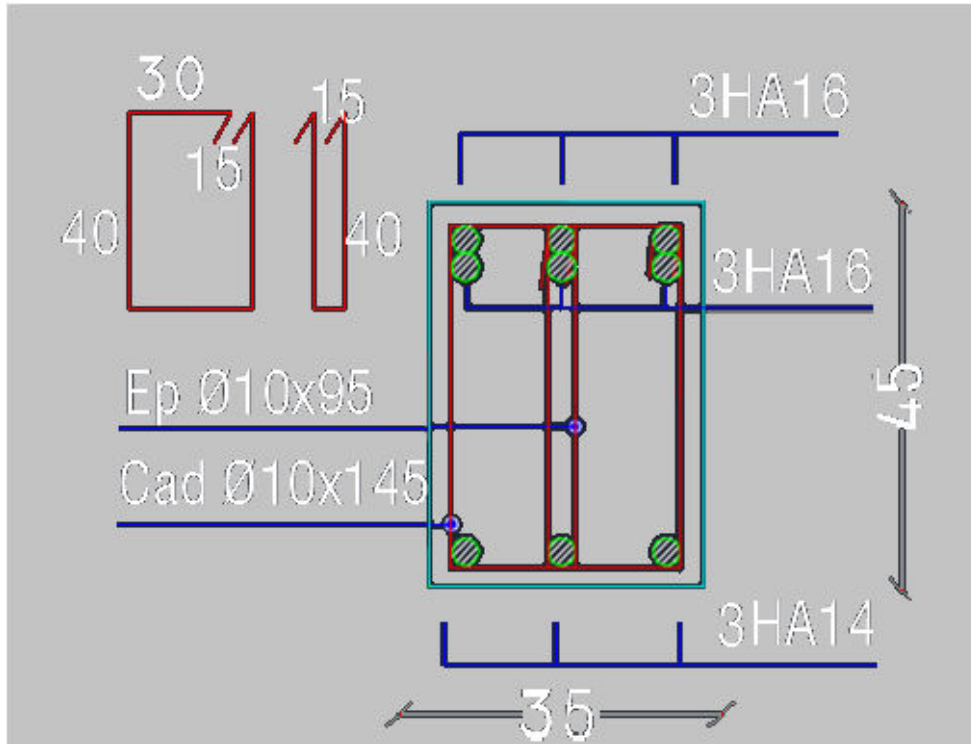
Ferrailage des poutres principales au niveau d'appuis de RDC et 1<sup>ème</sup> étage.
